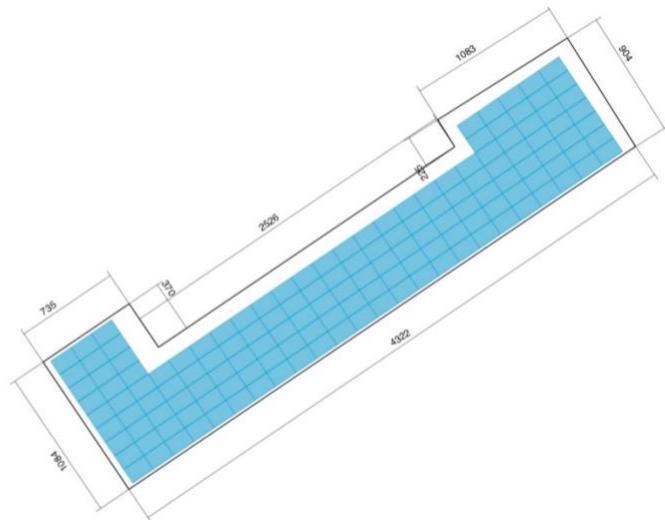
Schulhausstrasse 11, Belegungsplan, Dachfläche 2
